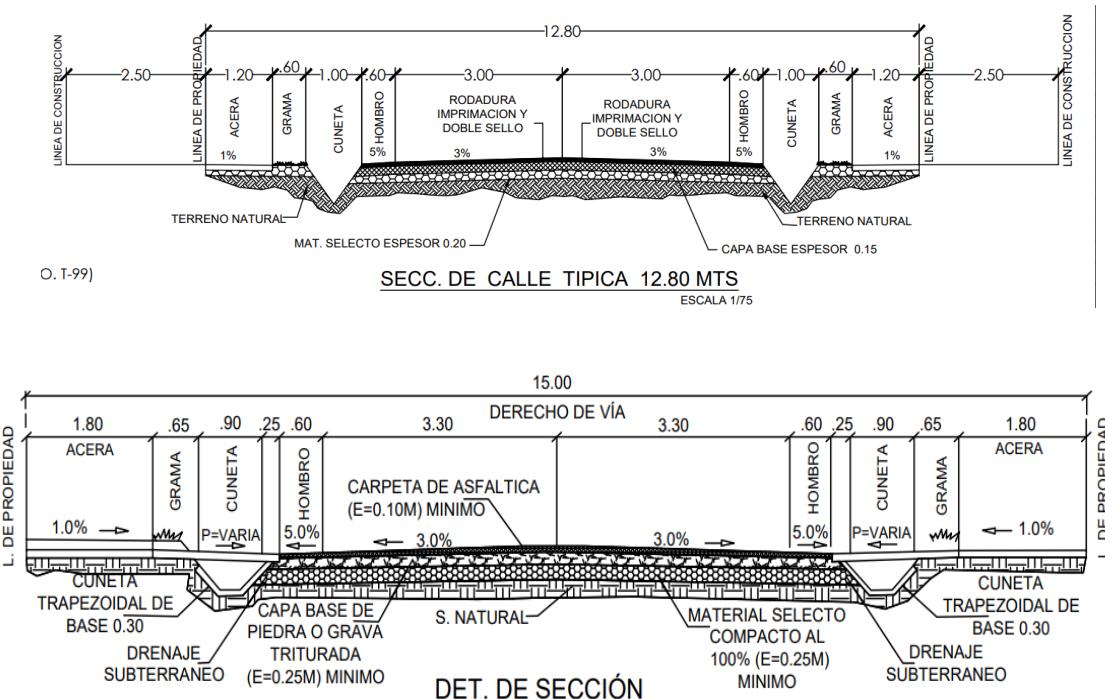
Sección típica de calle de 12.80 y 15.00 metros.
